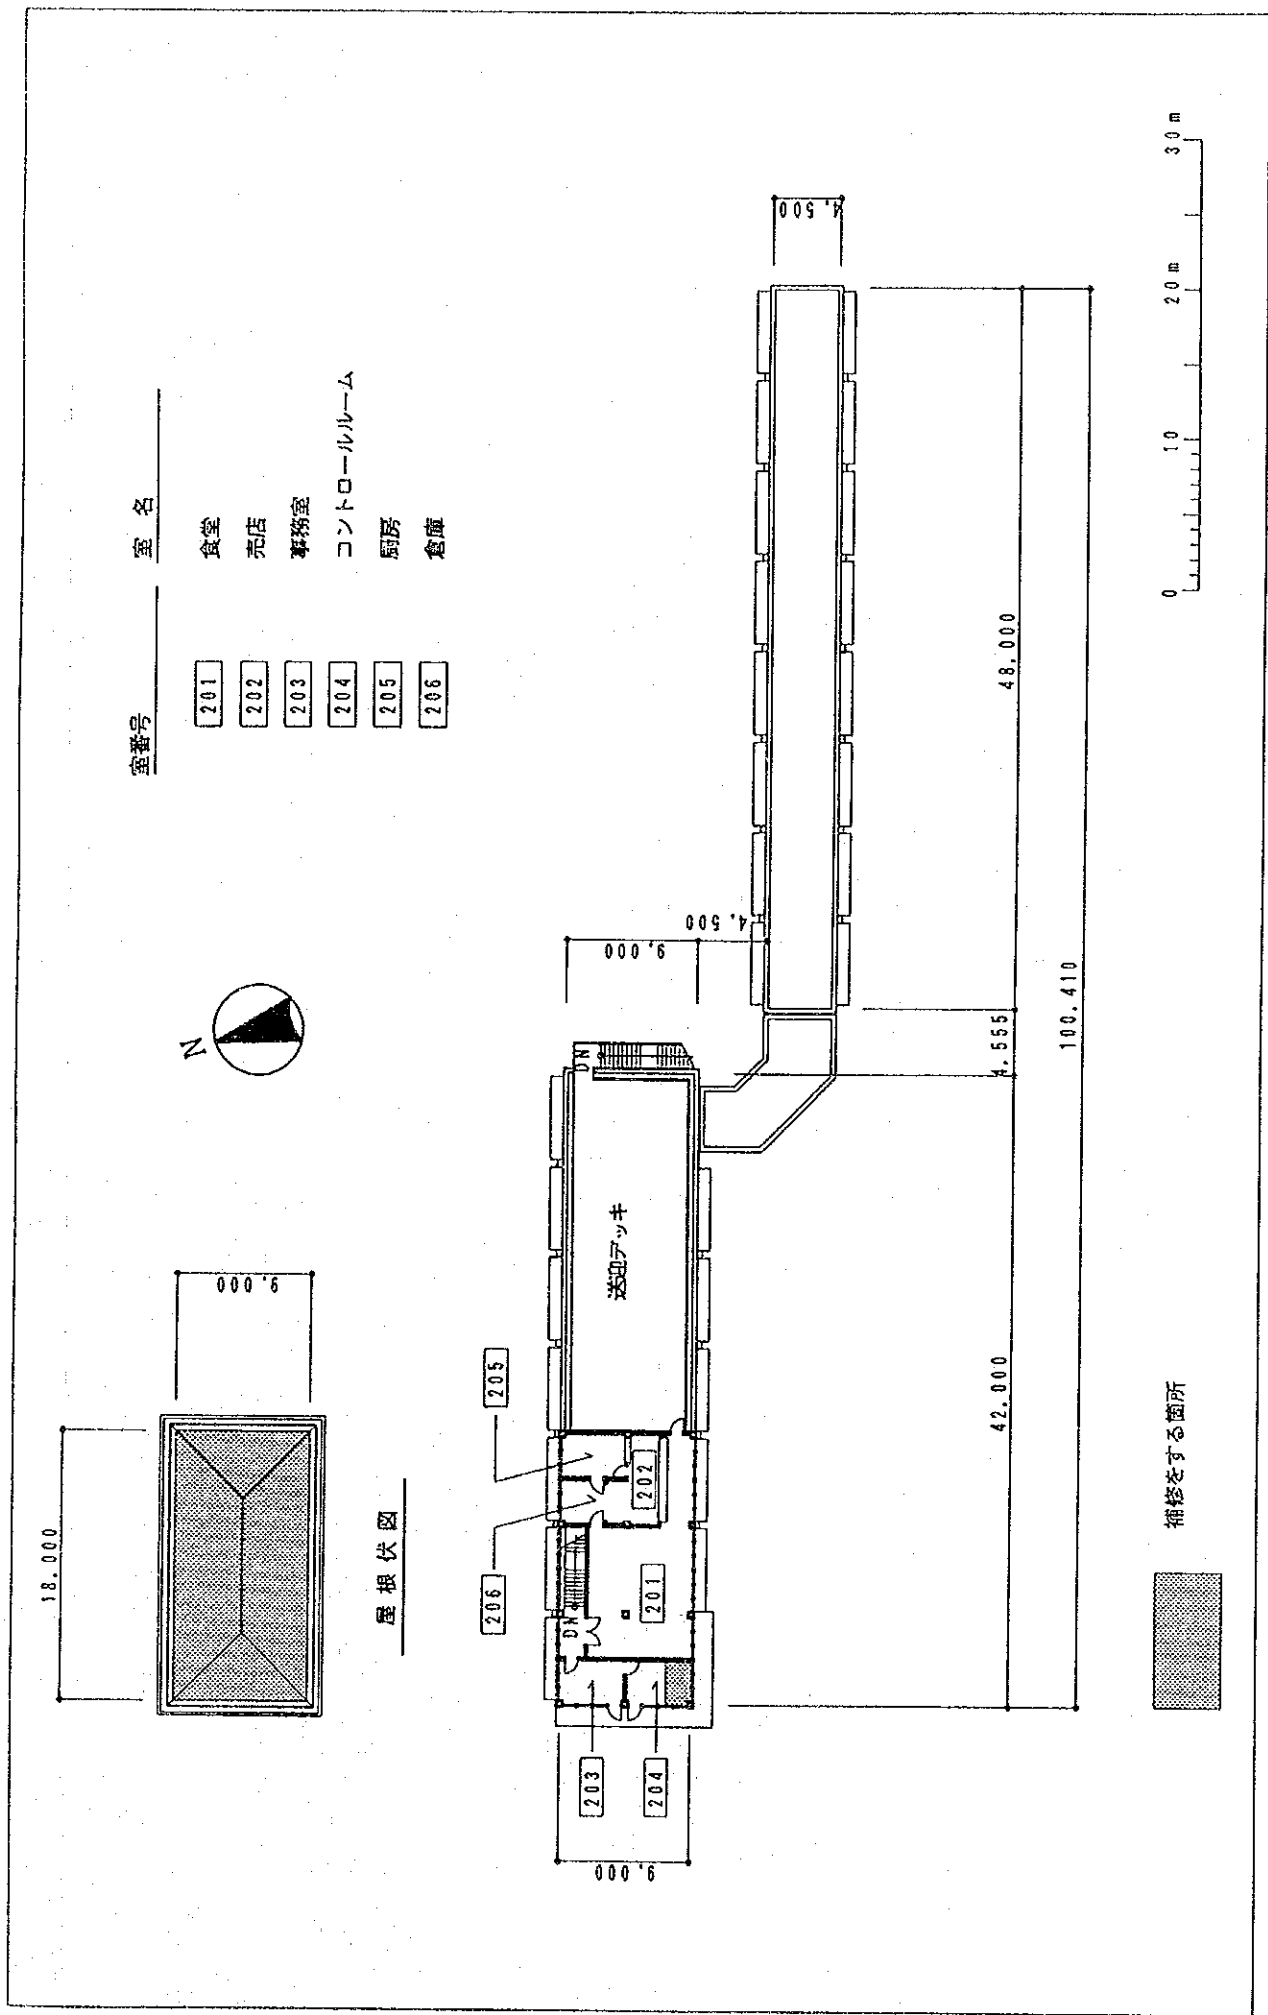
ムリファアヌア港 フェリターミナルビル2階平面図
